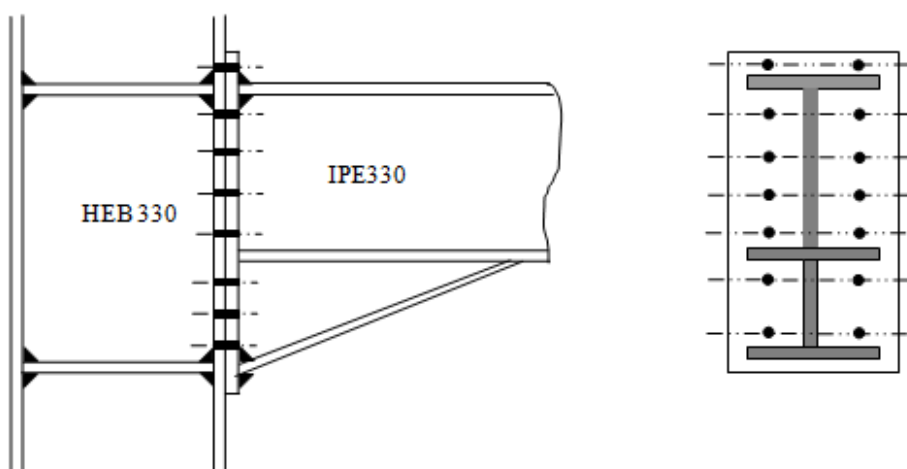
assemblage poteau- poutre (HEB320 -IPE330)
